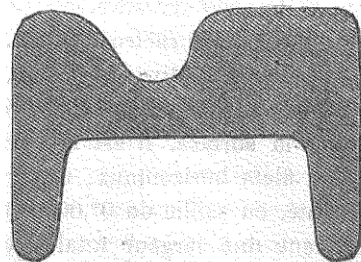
Section du rail dans l'avenue de Neuilly, 30 kil. par mètre courant. Échelle 1/2.
